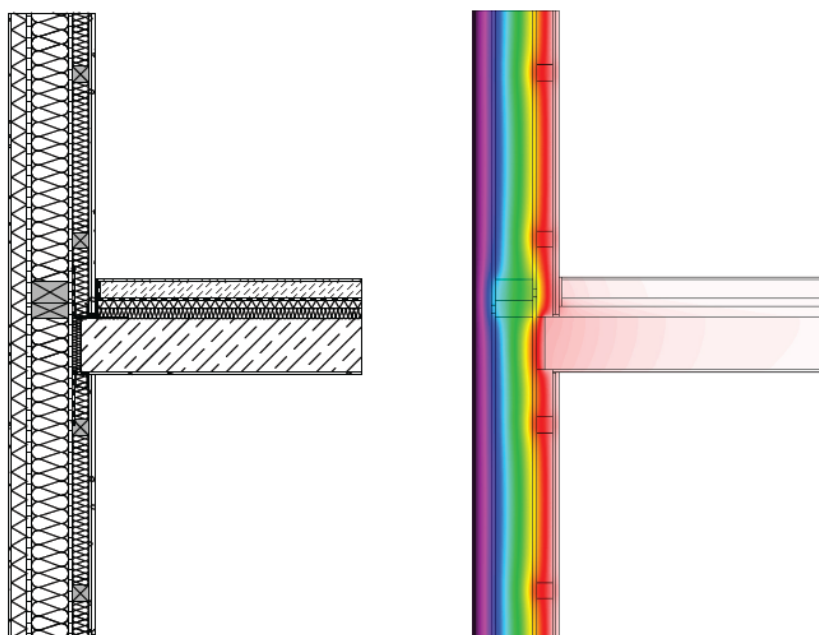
Anschluss Geschossdecke - Außenwand, vorgestellt mit Darstellung des Isothermenverlaufs (Eigene Darstellung)
